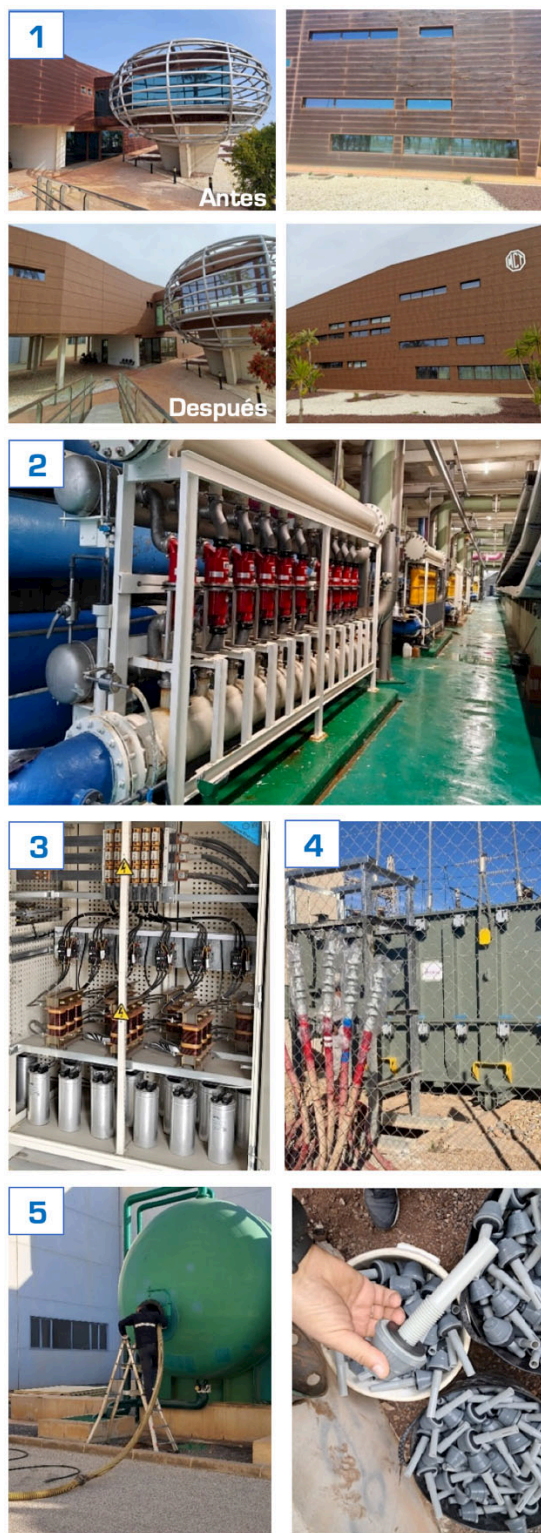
Fotografías de las mejoras llevadas a cabo en 2024. En la planta de Alicante: Reformas en la fachada (1), Flex nuevos en el bastidor I de la línea II (2), Batería de condensadores (3) y cambio crepinas filtros de arena (5). En la planta de San Pedro, nuevo transformador (4)
